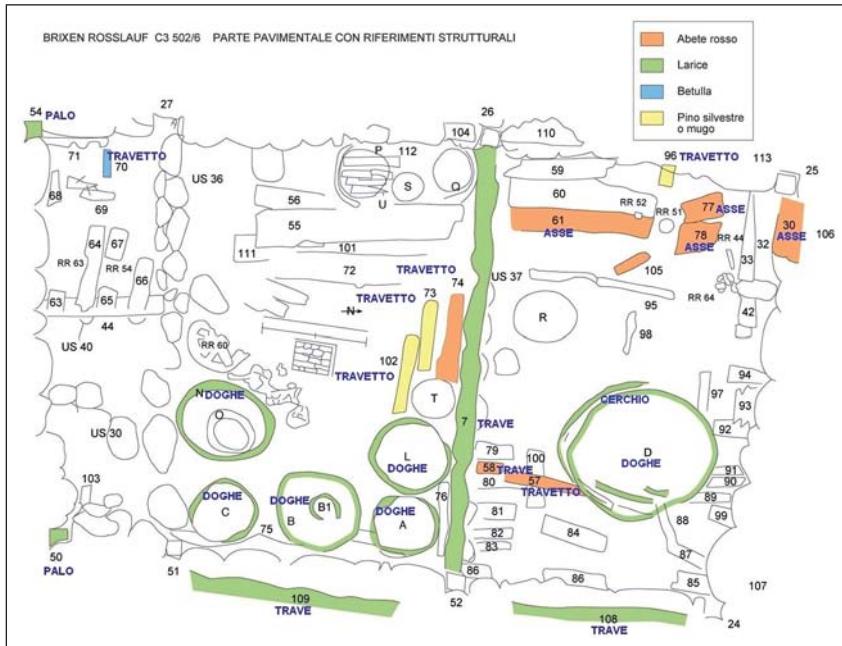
Planimetria della casa di Rosslauf con rappresentate alcune strutture e manufatti⁽²⁾.
